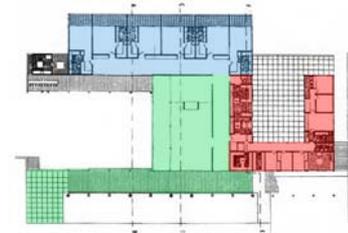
Planta da Casa Adolpho Bloch. Sem escala. (Fonte: Arquitetura Revista n. 6, 1988).
